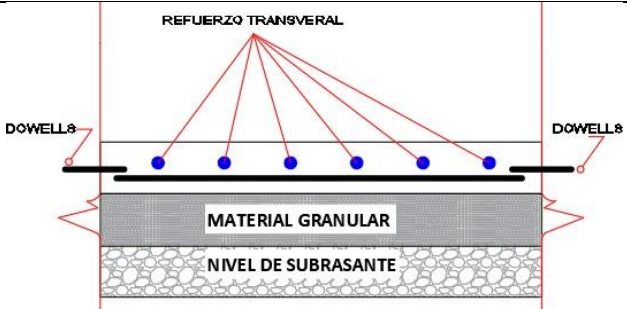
Niveles de capas estructurales de un pavimento de tipo rígido. Fuente propia.
